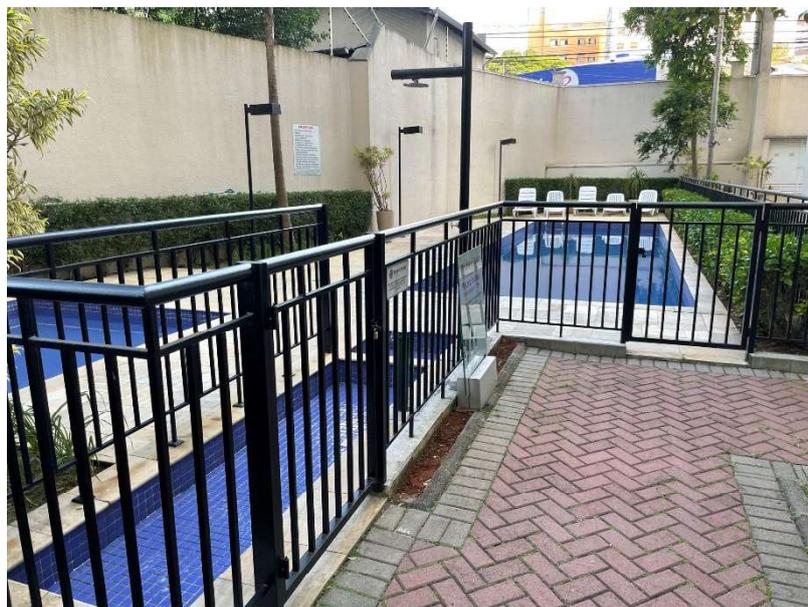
CONDOMÍNIO FATTO SÃO BERNARDO DO CAMPO –
